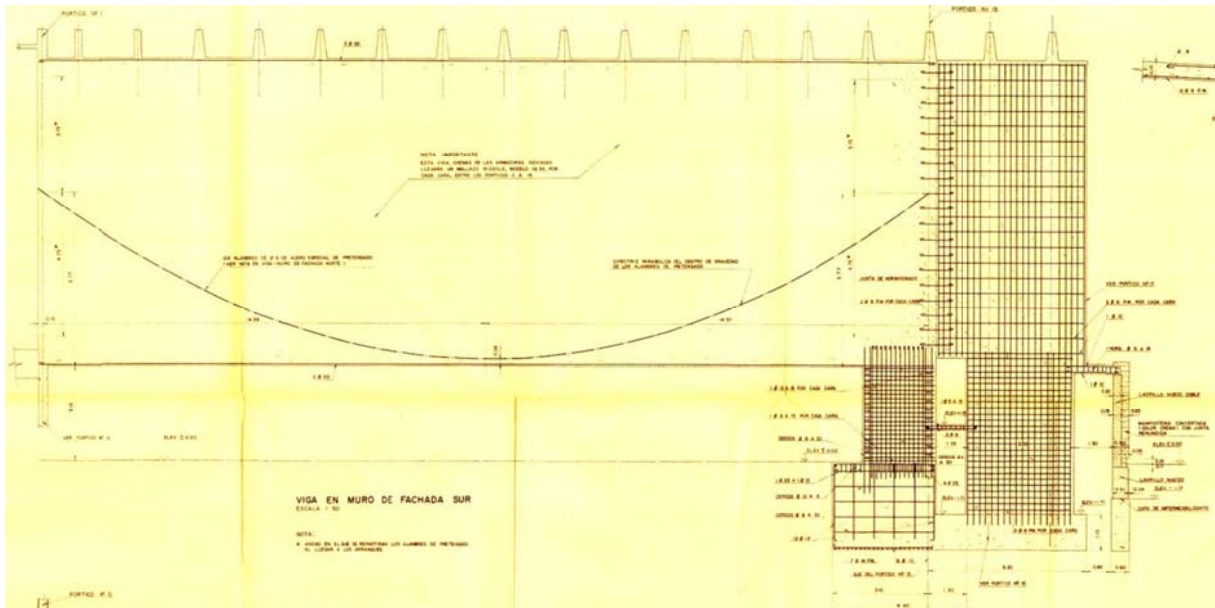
Lámina Sur. (Nadal, J. 1960)
